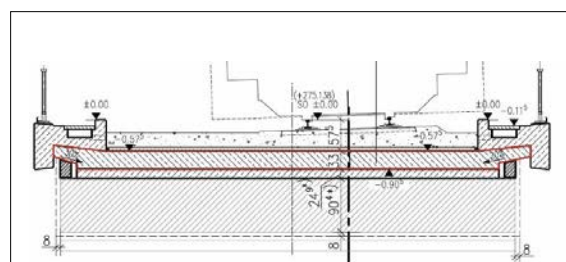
Stahlbetonfahrbahnwanne aus Ortbeton
